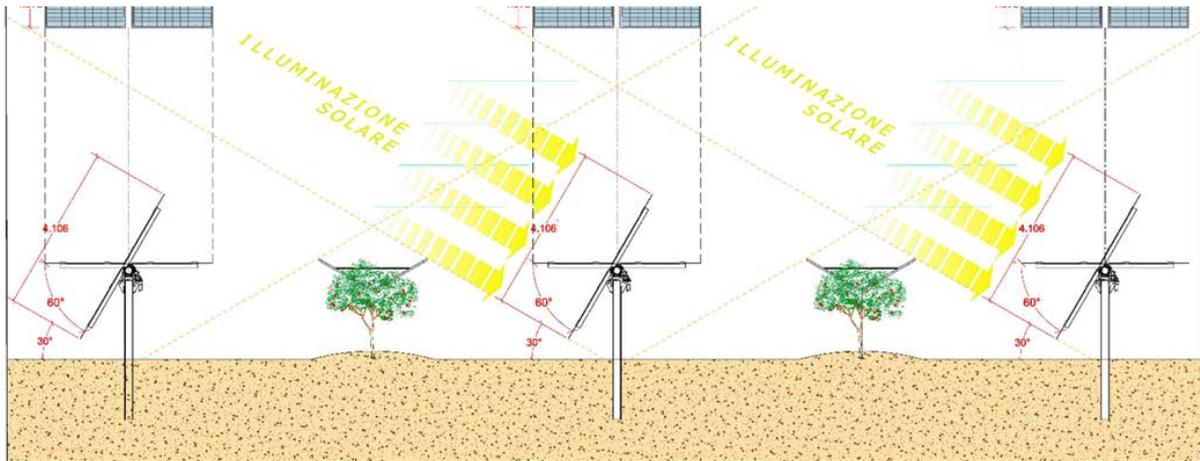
Sezione d'impianto con indicazione degli ingombri delle strutture ad inseguimento solare.
